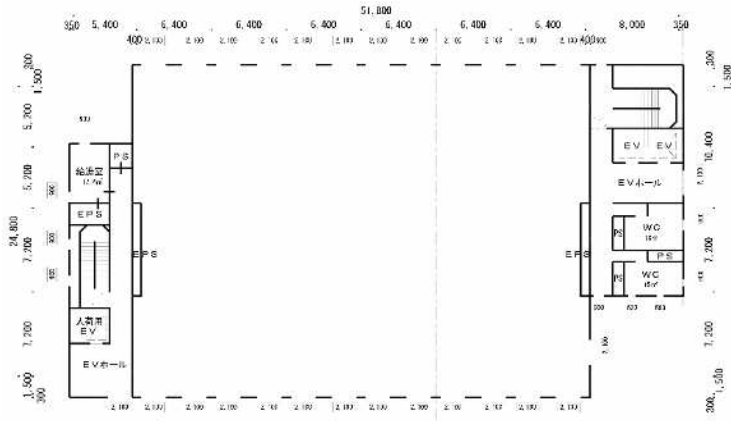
庁舎モデル(3,000 m²)検討モデル 平面図
